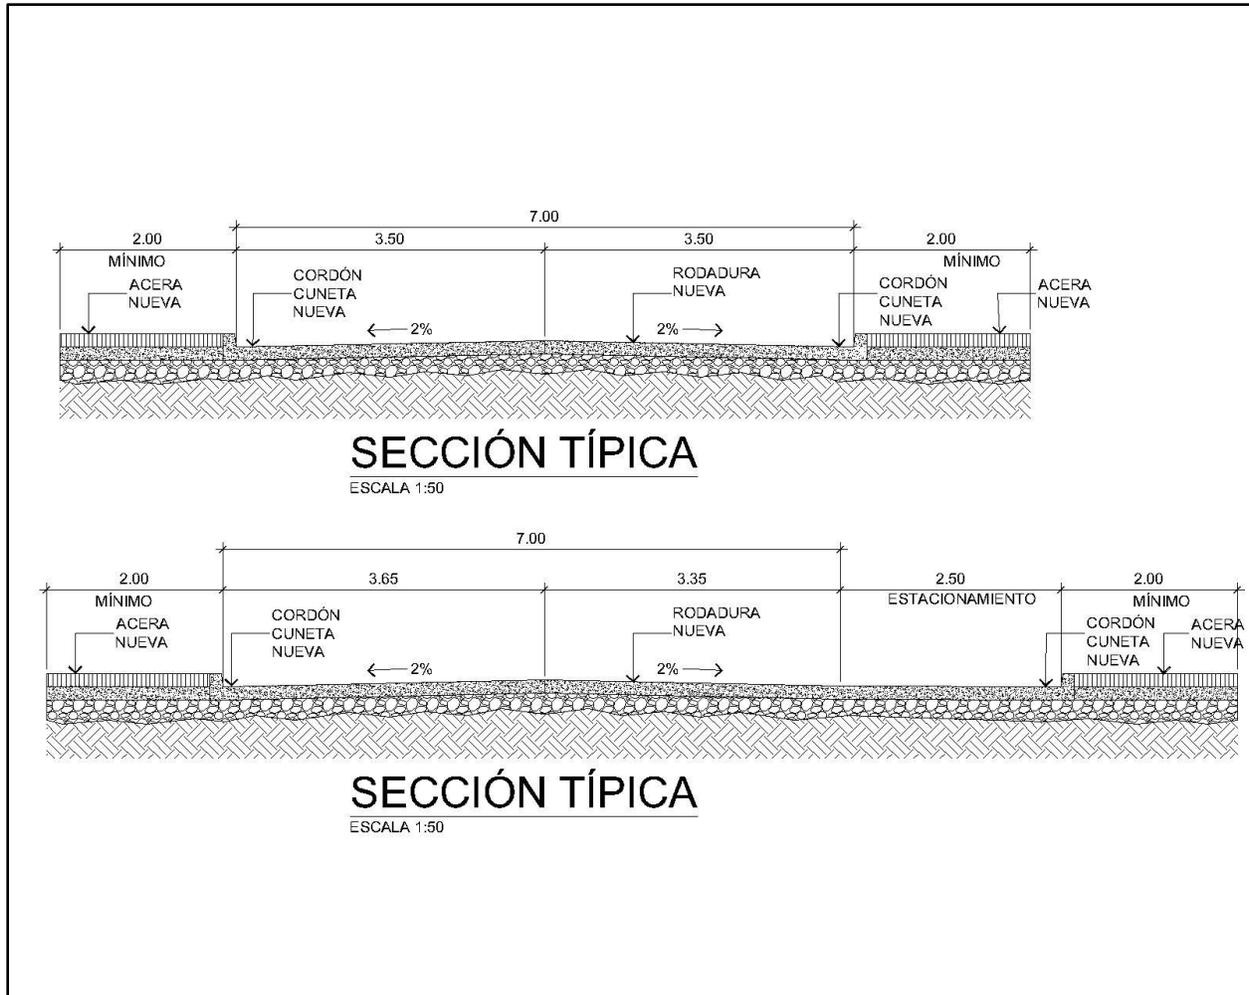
SECCIONES TIPICAS ANTEPROYECTO
